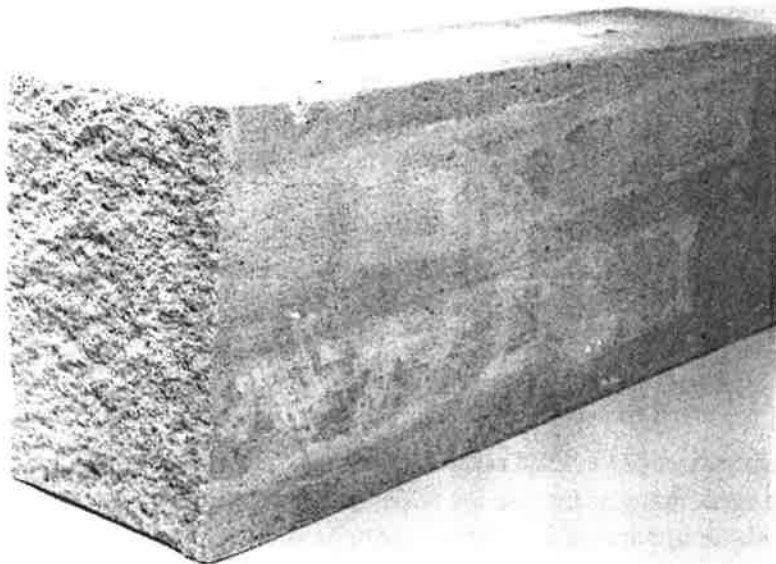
Poutrelle en béton mousse (80 × 15 × 10 cm) ayant été coupé au milieu, ce qui montre la structure poreuse.
